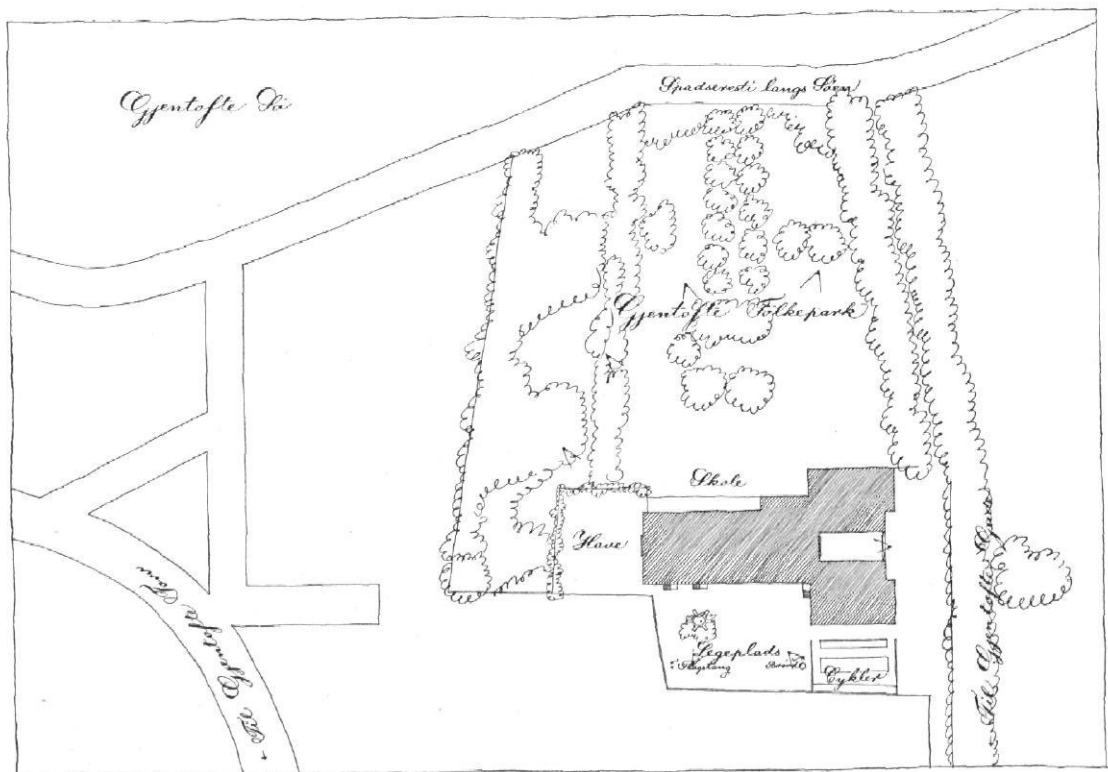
| Staatsskule in Gjentofte, Dänemark | Lageplan, 1:2000
